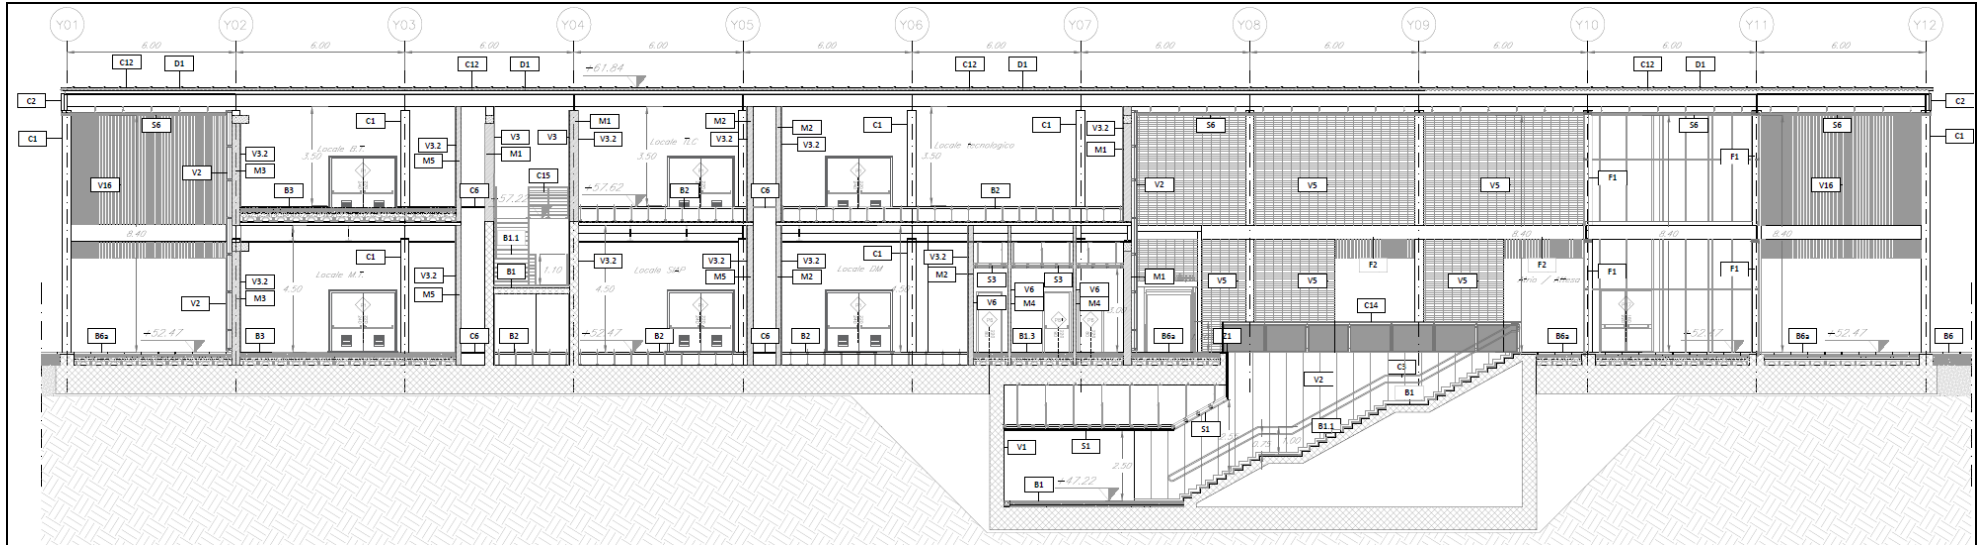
Stazione Teleso – Sezione longitudinale (Rif.: [14])
